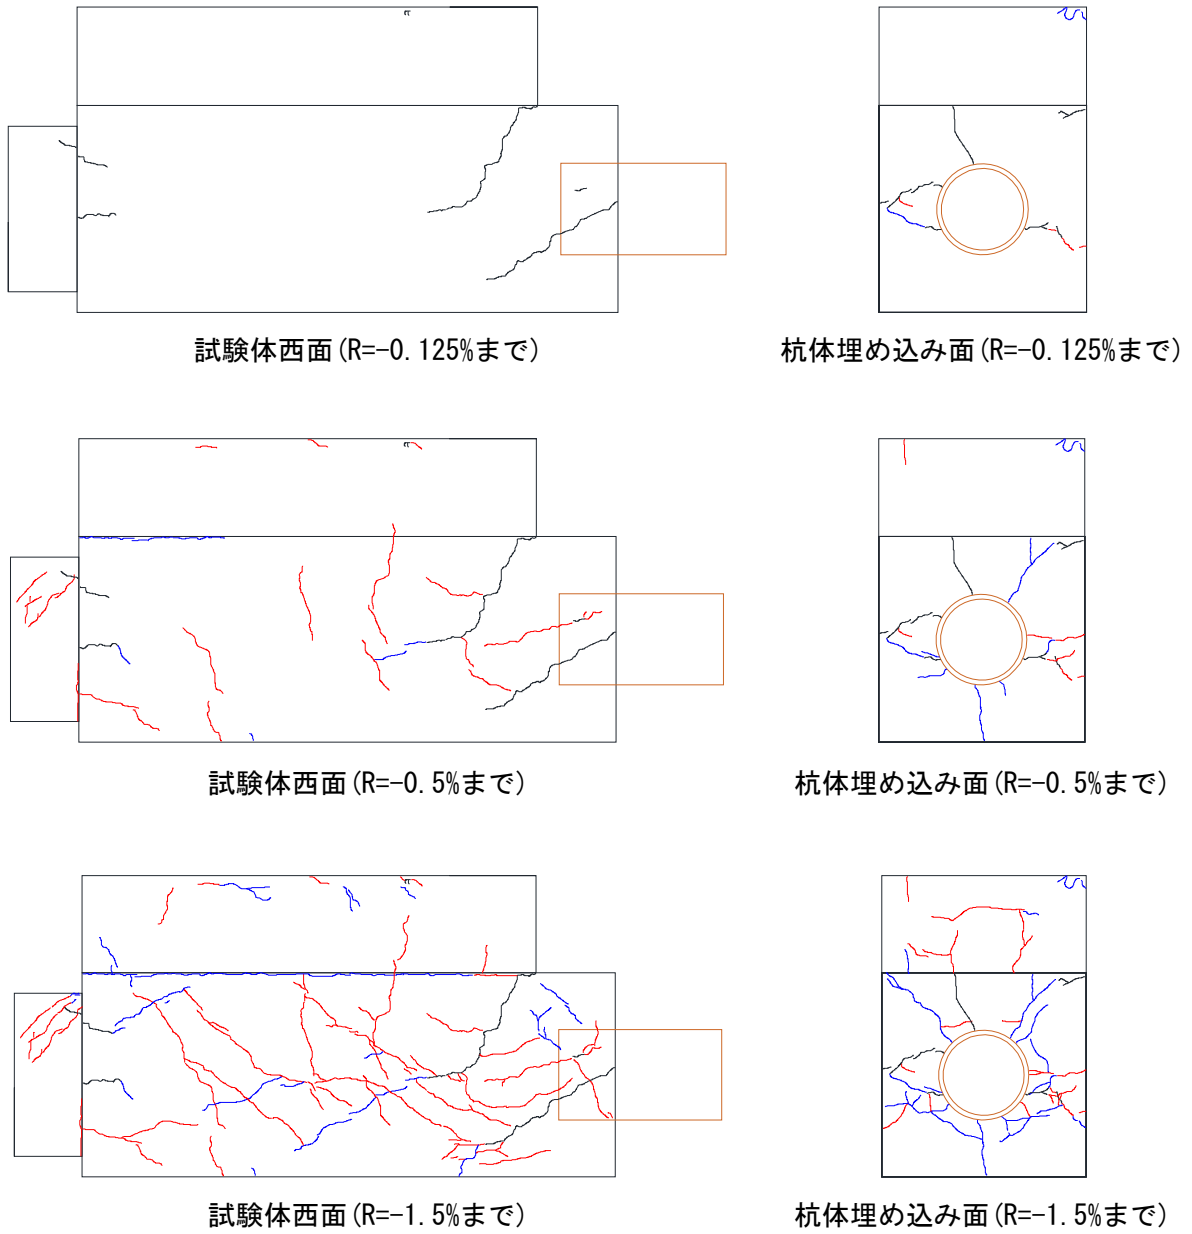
試験体 No. 2 のひび割れ進展状況
